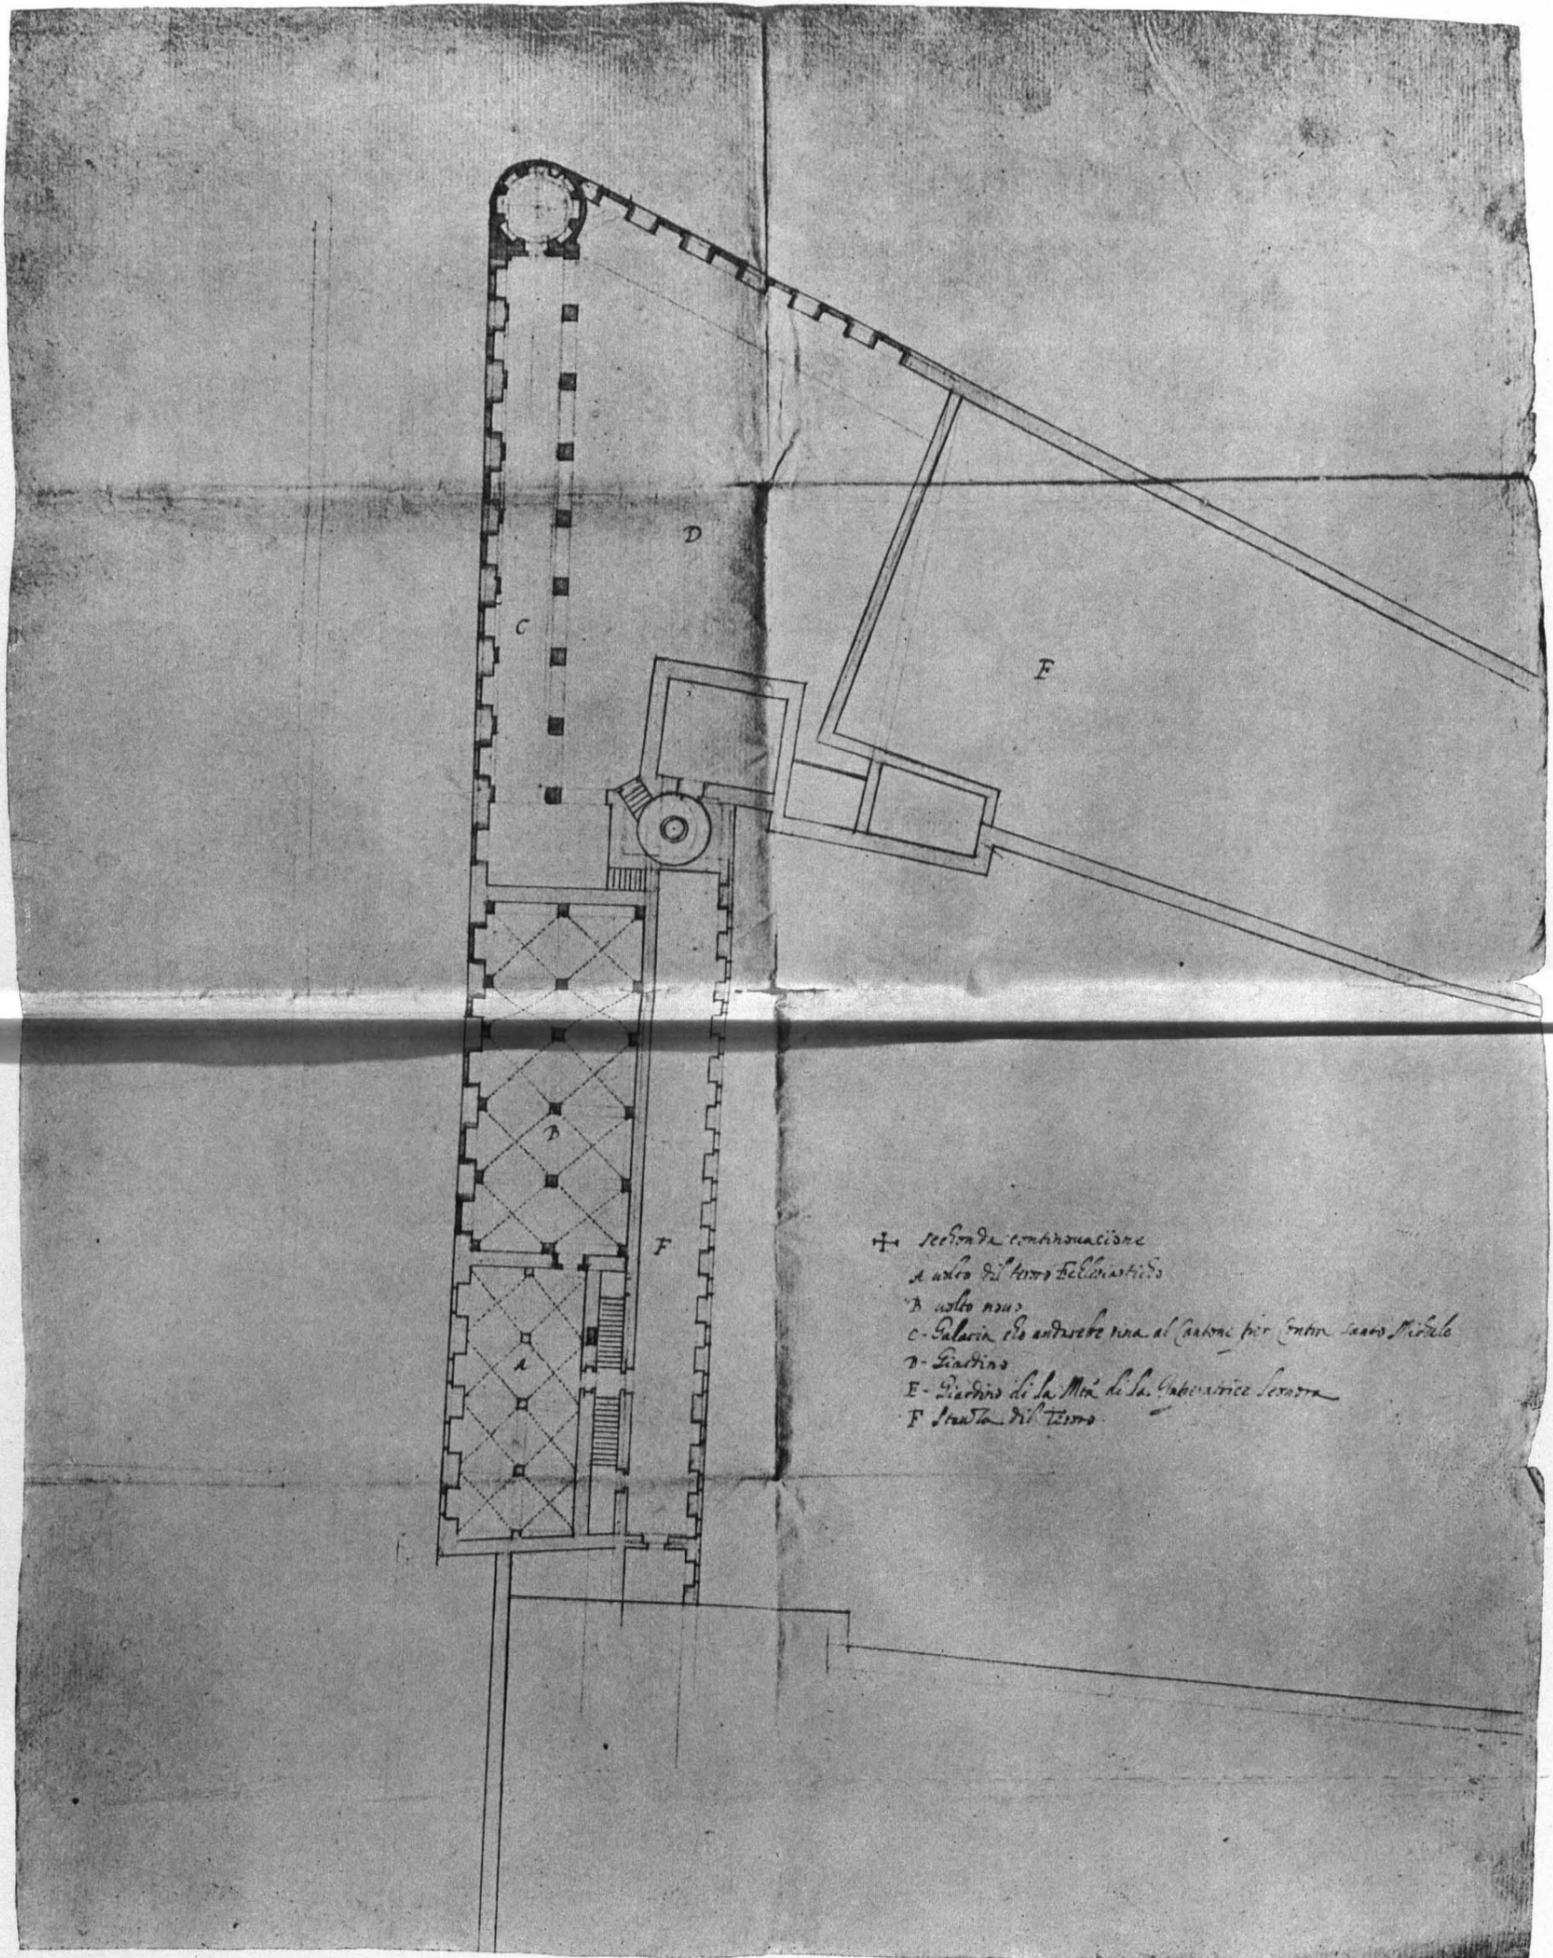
Grundriß des Ballhauses mit Umgebung und Vorschlag einer Erweiterung, aus den Jahren 1640—41, Federzeichnung, zum Teile laviert, k. u. k. Gemeinsames Finanzarchiv
